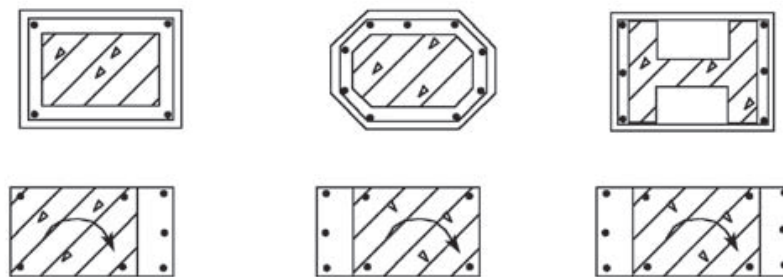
Reforzamiento de columnas mediante el incremento de la sección transversal.
